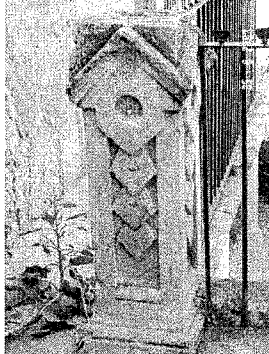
Pilastra de cantera desgastada, pasillo exterior con barandal desprendido
